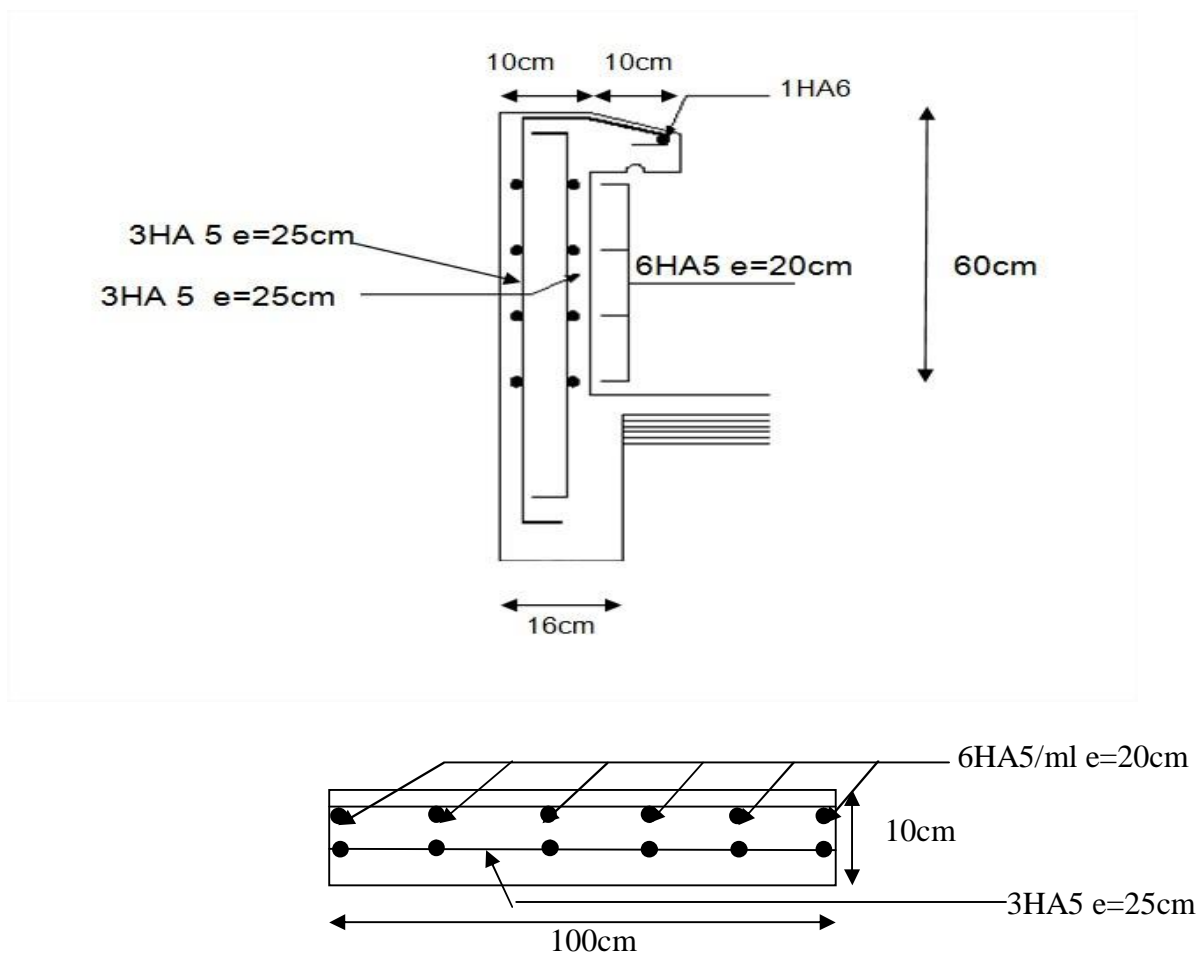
Coupe verticale et horizontale du ferrailage de l'acrotère.
